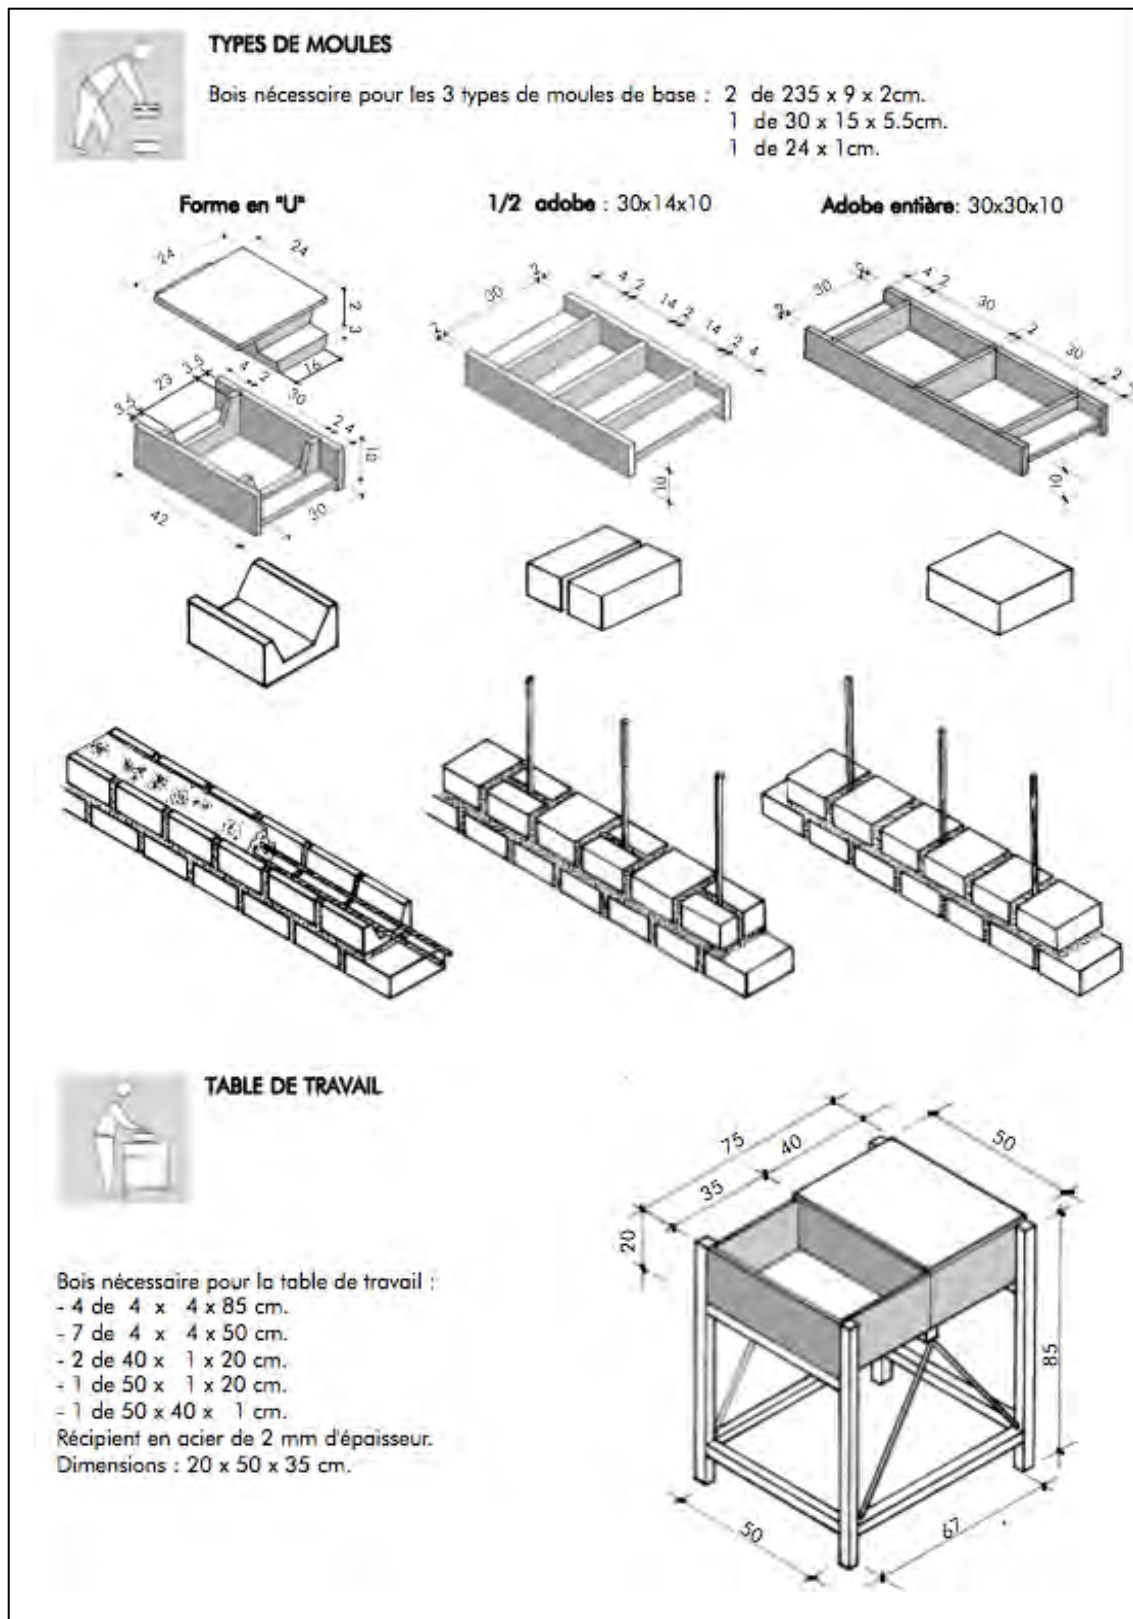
Divers types de moules pour la fabrication de l'ADOBE.
